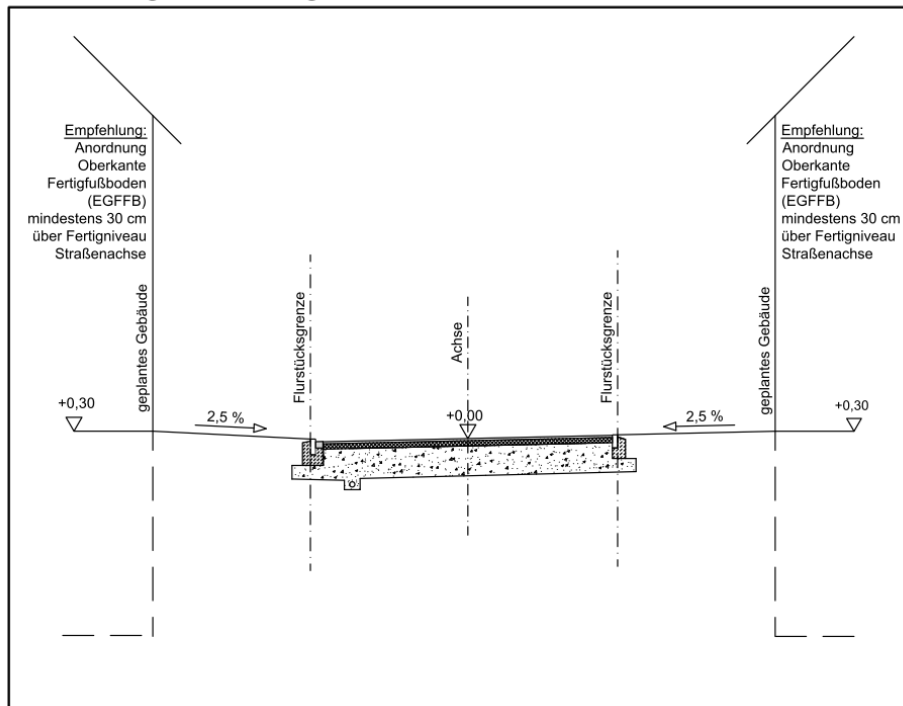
Geländeschnitt der Straßenplanung i. V. mit Grundstücksgefälle zur Straße (Ing. Büro Reihnsner 2024)
